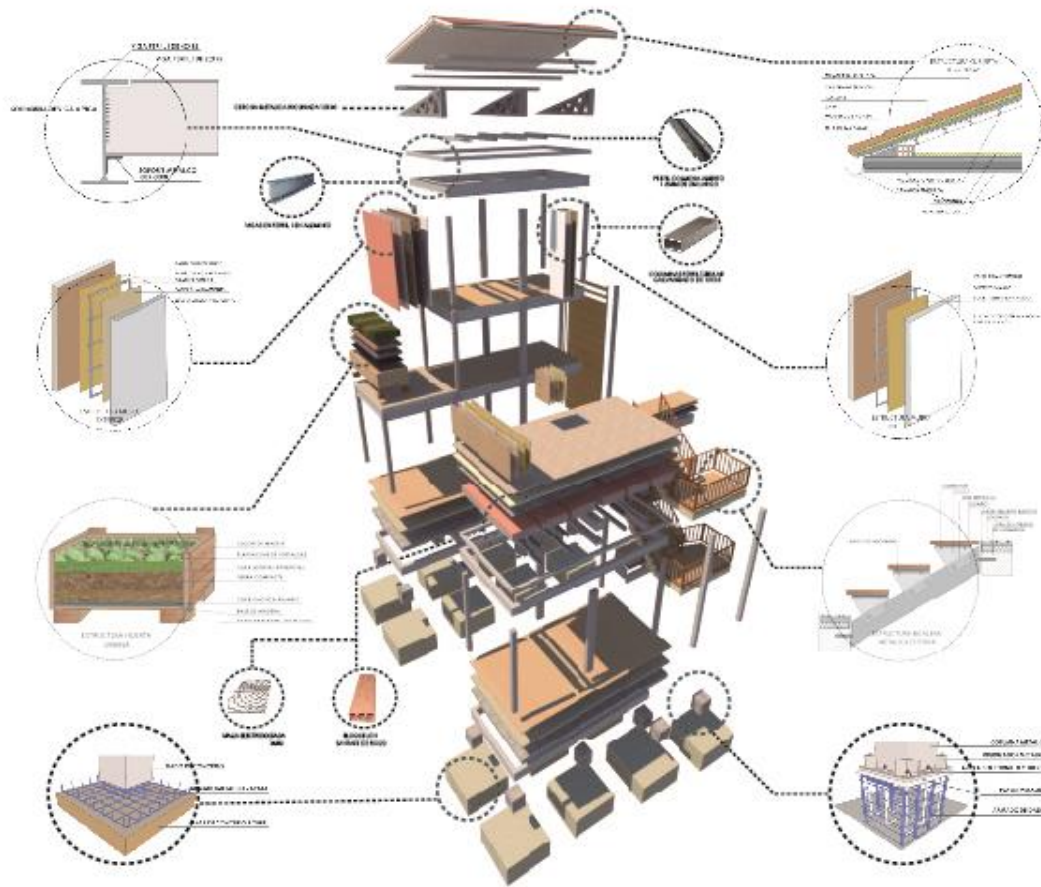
Sistema Constructivo Modulo de Vivienda con detalles
